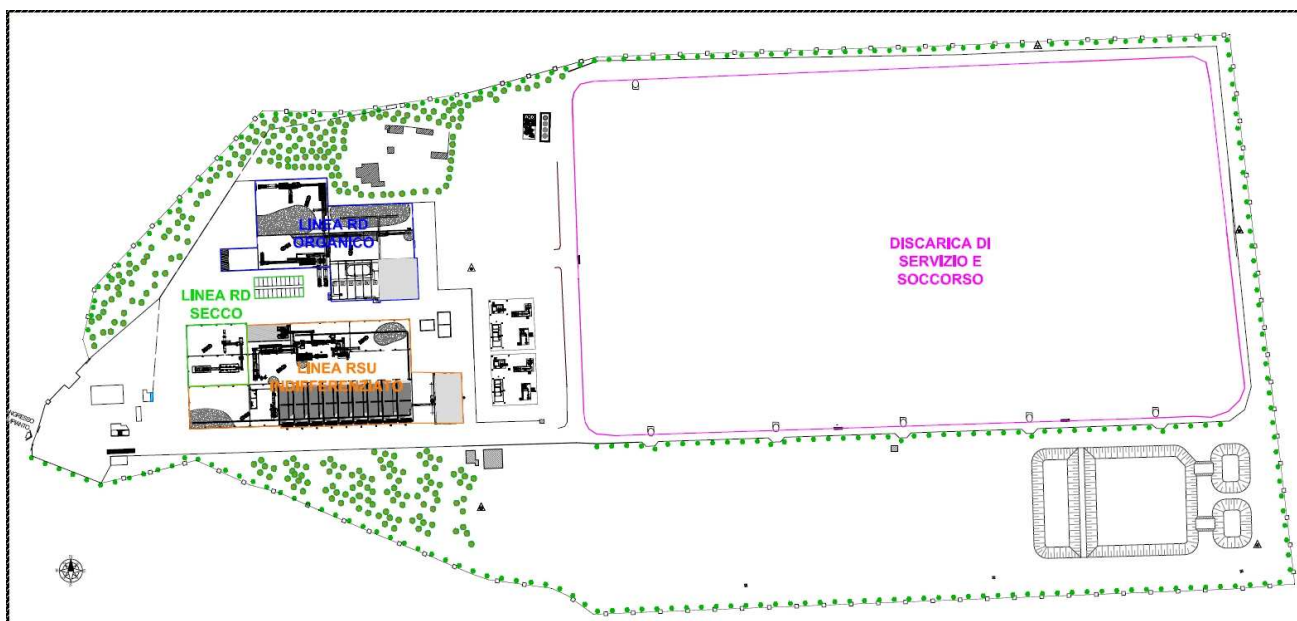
Planimetria generale del sito con ubicazione delle diverse linee impiantistiche
